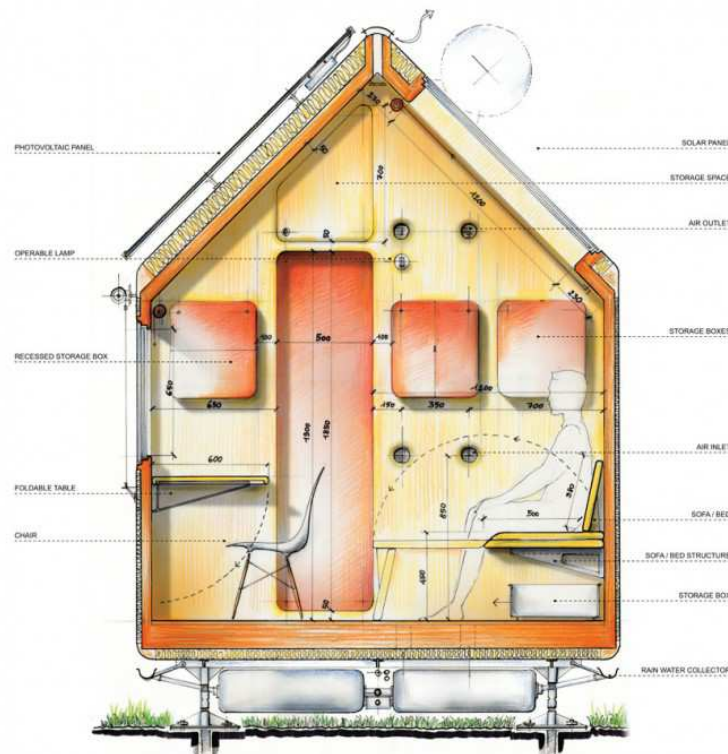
Renzo Piano. *Corte 2 - Sala e dormitório.* Fonte: Renzo Piano.
